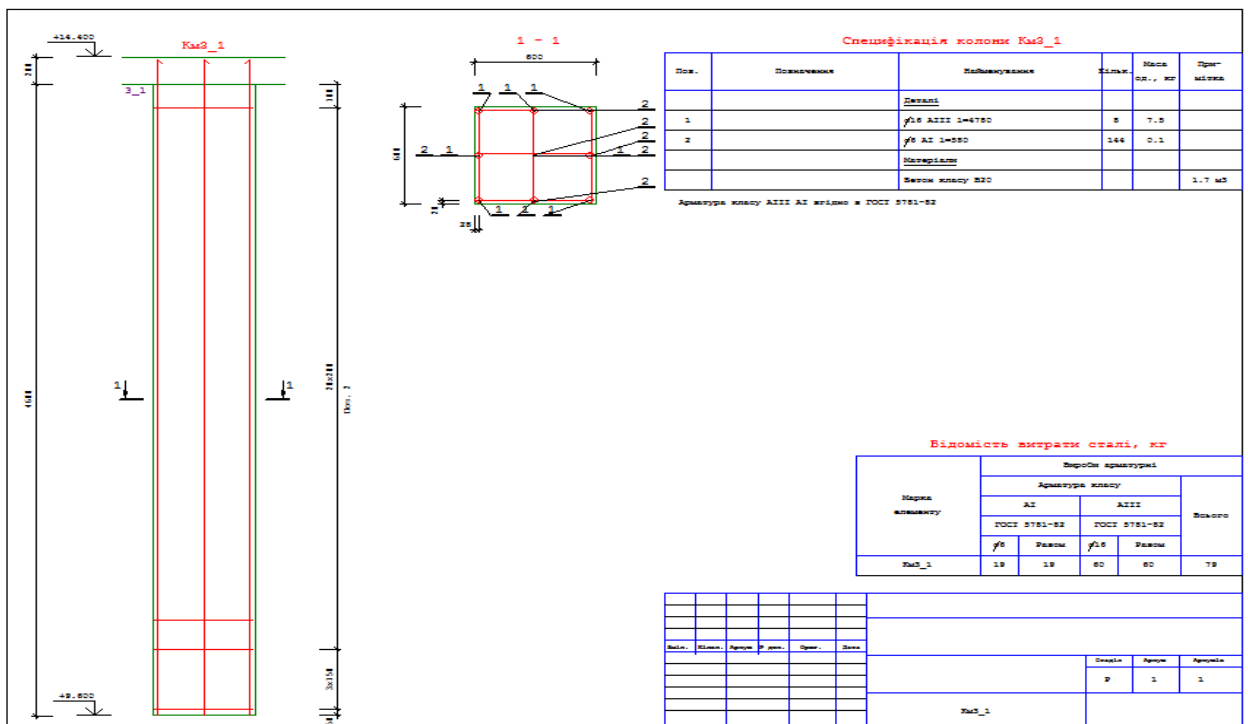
Варіант будівлі з плитним перекриттям. Колона К3-1. Креслення робочого проекту.
